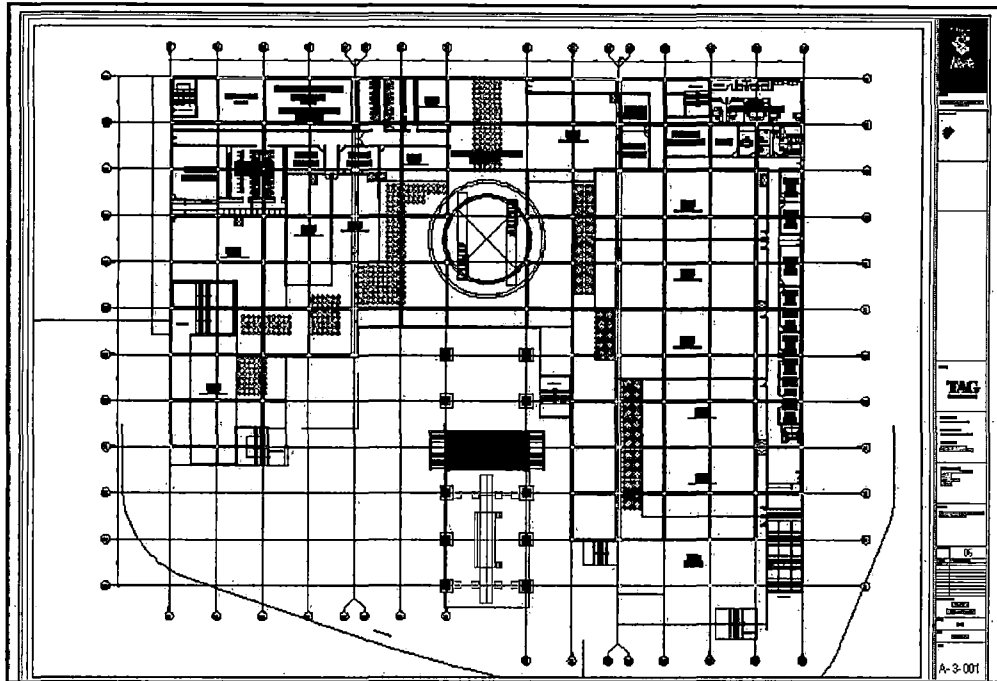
PLANTA PRIMER NIVEL DEL SECTOR 03.
